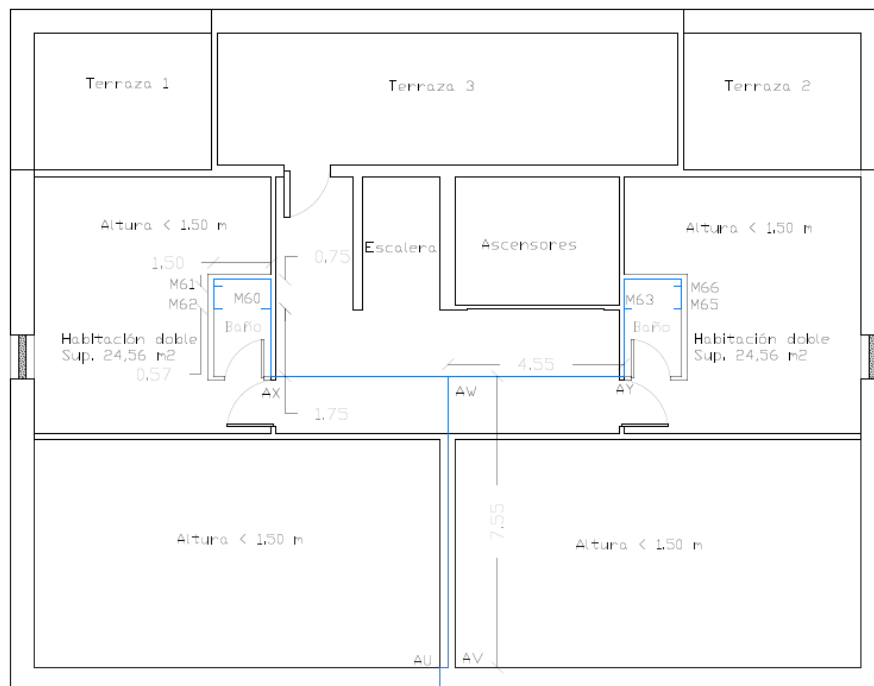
Plano de la red de suministro de agua en la planta bajo cubierta. Fuente: Elaboración propia
